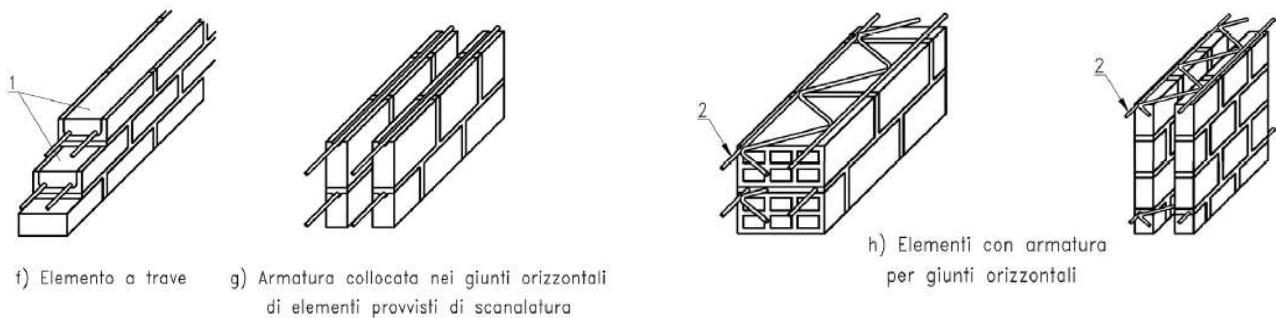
Tipologie di muratura armata: 1) calcestruzzo di riempimento; 2) armatura posizionata nella malta
